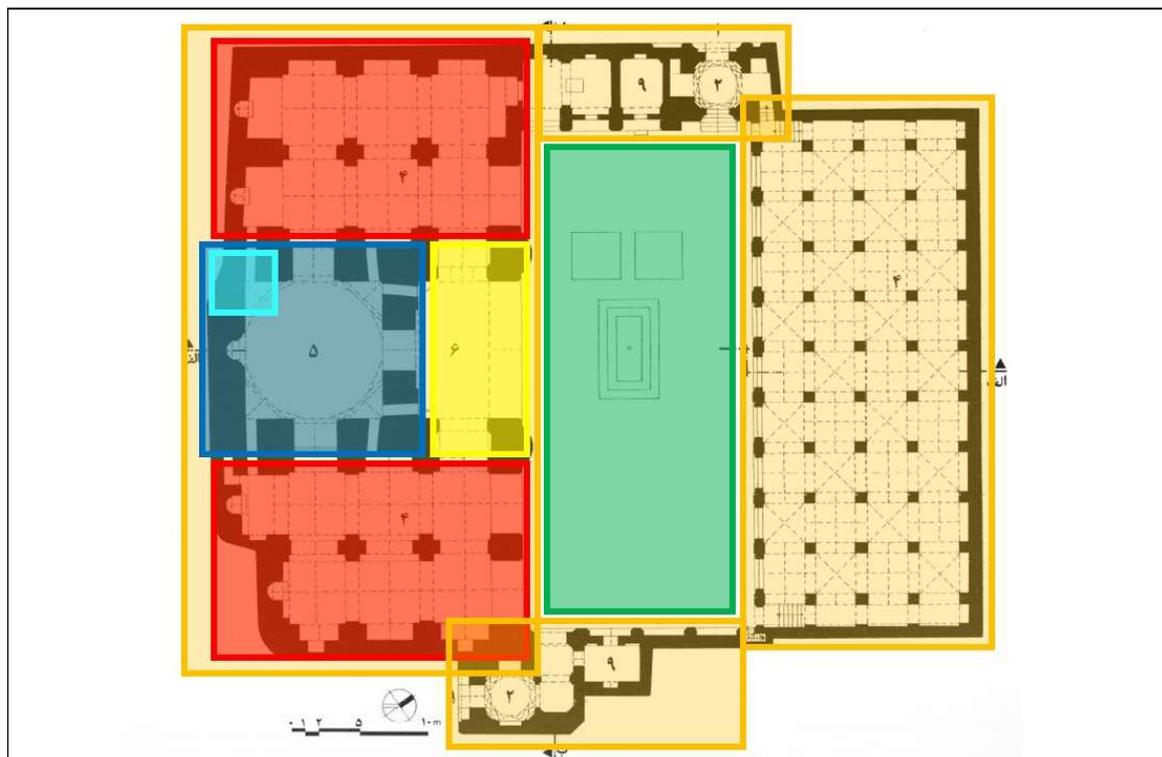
Grundriss, Grafische Darstellung der Teilbereiche
